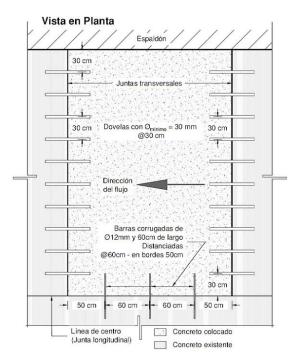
Recomendación del procedimiento de instalación de barras de acero (dovelas y barras corrugadas) en las juntas transversales y longitudinales
